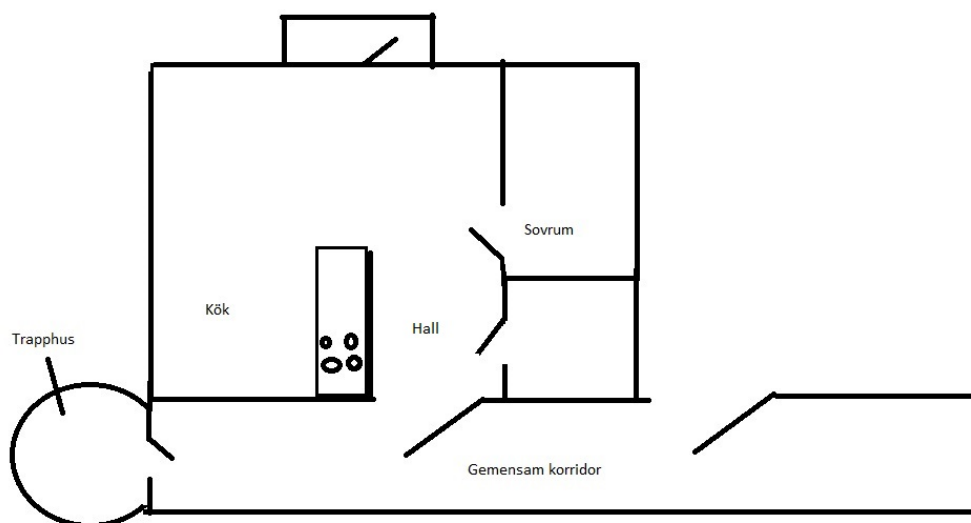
█████ egen planritning över lägenheten. Ej skalenlig.
